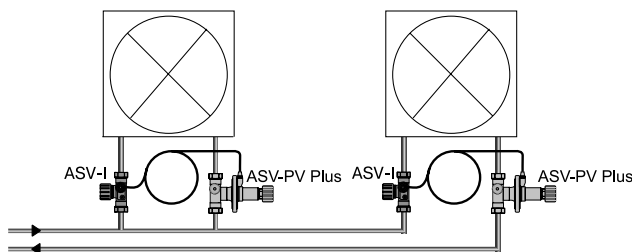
Клапаны ASV-PV Plus и ASV-I перед вентиляционными установками
